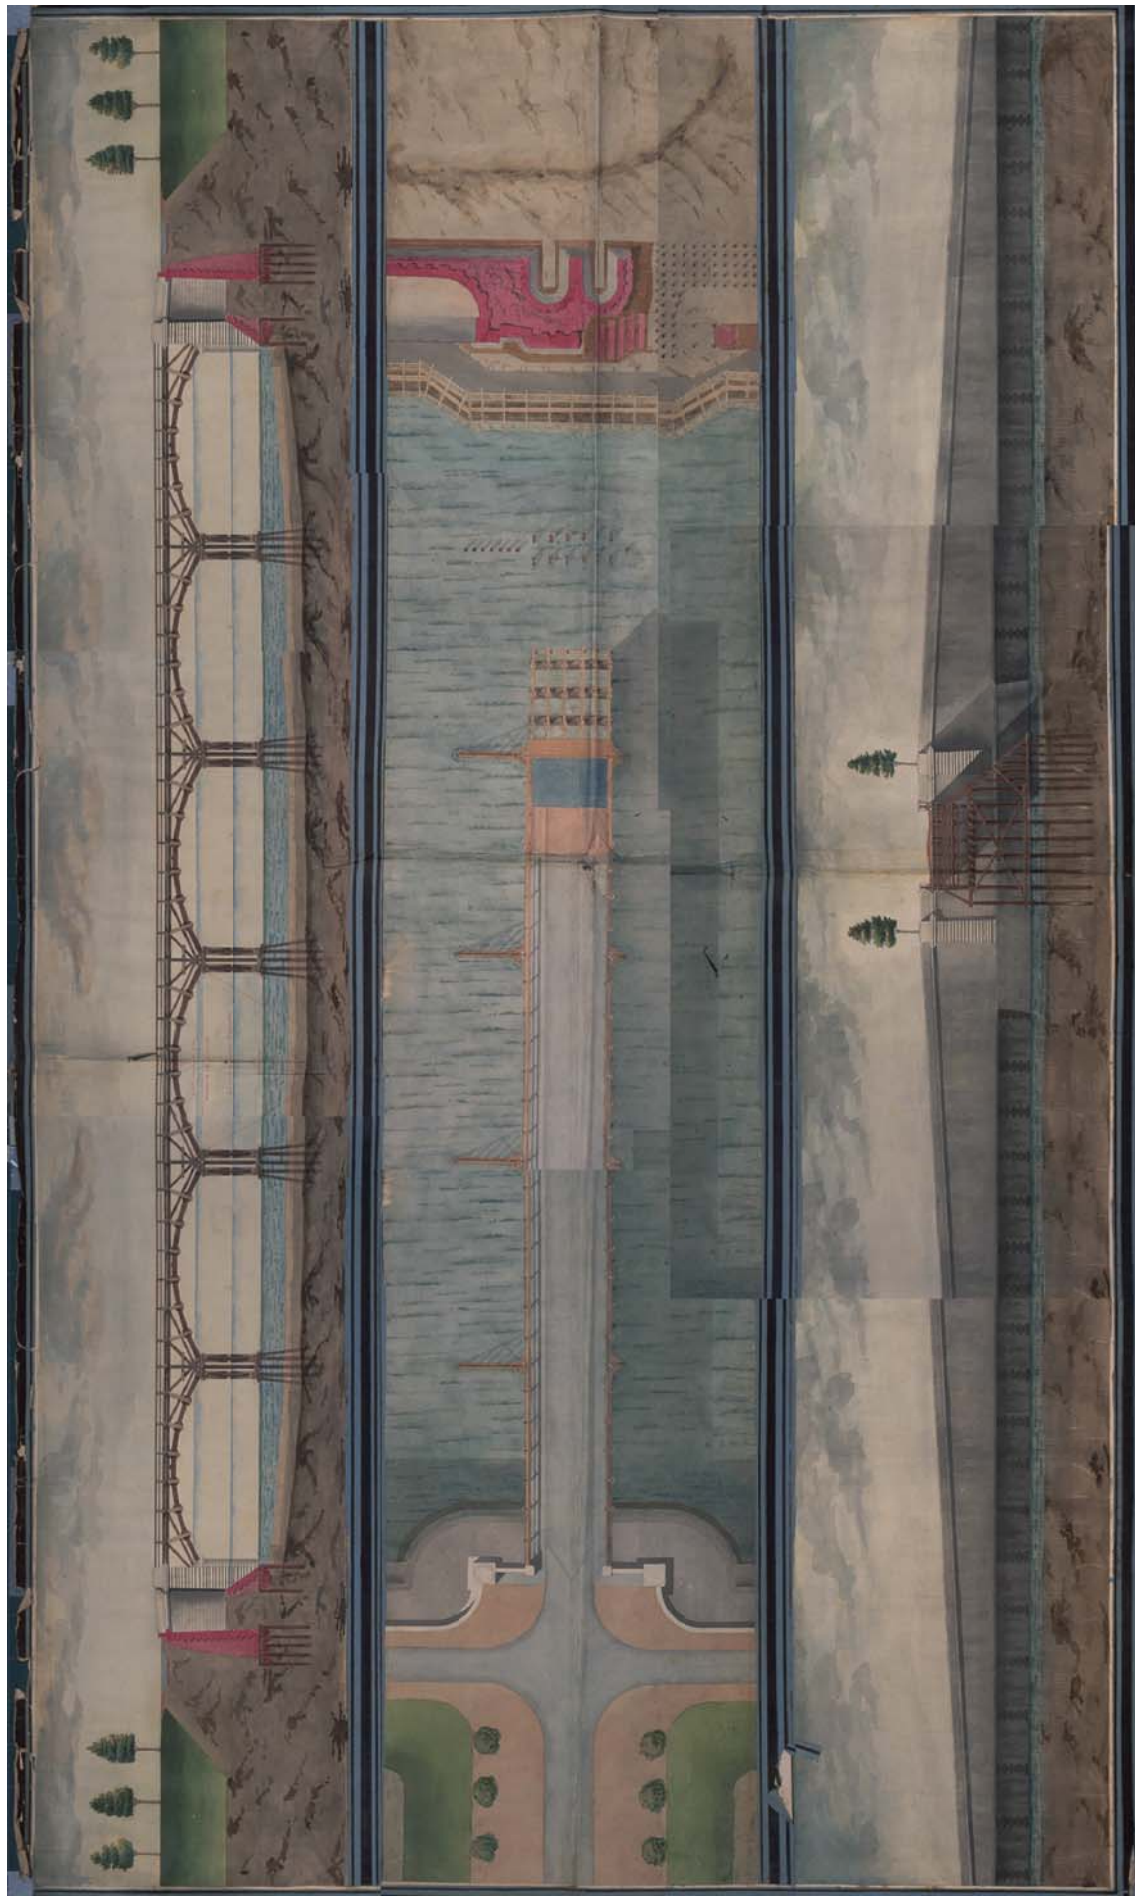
DG 497 – Pierre Advinez. Projet d'un pont en charpente. Elevation, plan et coupe. Concours pont. 17
